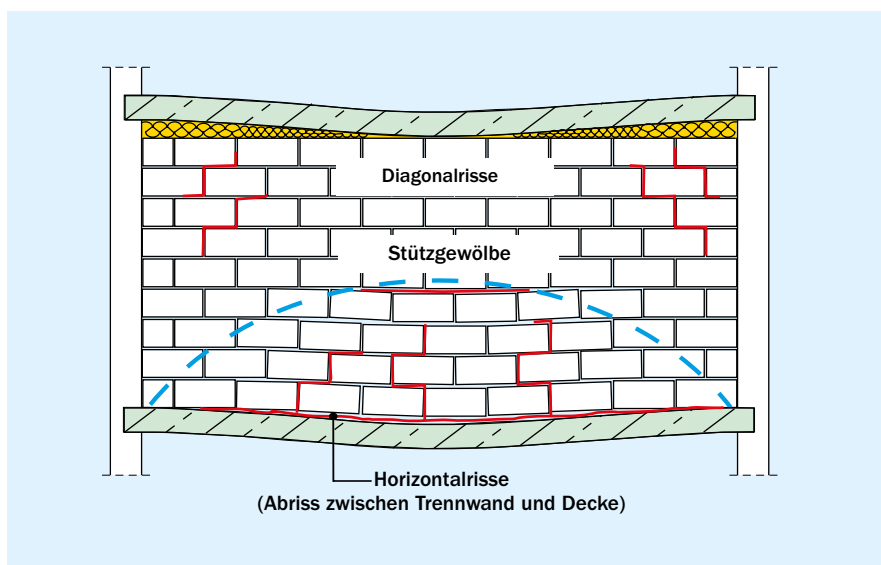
Riss in nicht tragender Trennwand infolge Durchbiegung der unteren Geschossdecke (Aufstandsfläche)
